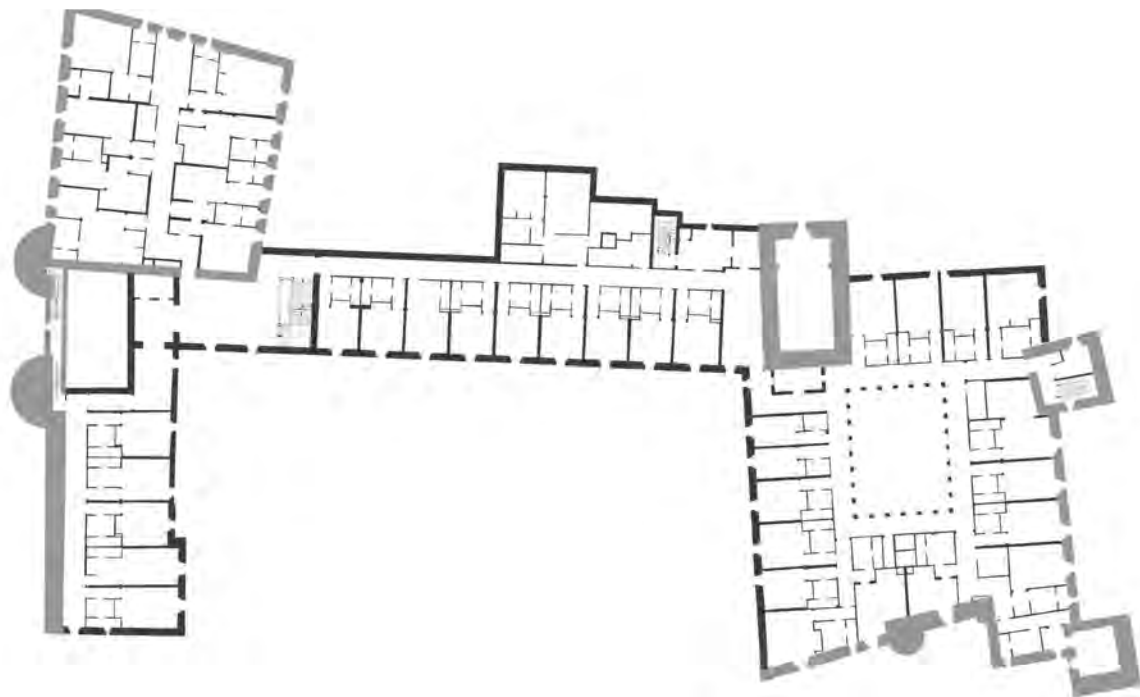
Planta primera del parador (Elaboración de la autora a partir del plano de Picardo, 1973, [AITE]).
